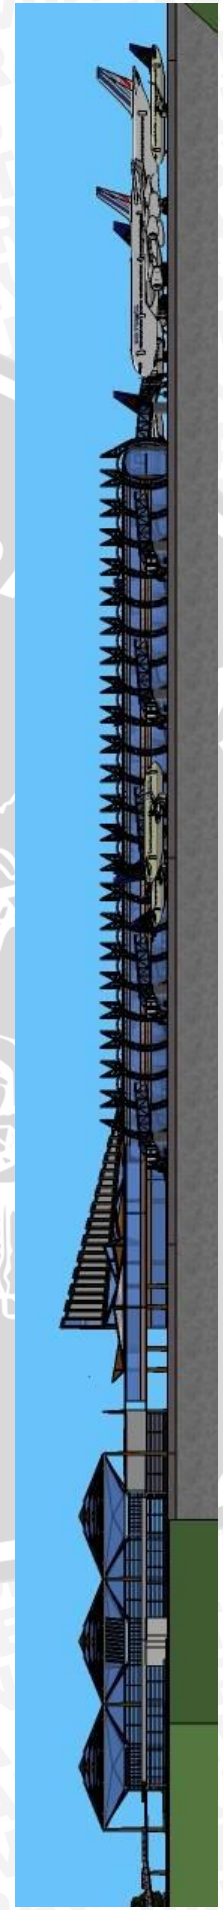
Tampak Terminal zona *Landside* alternatif 2
